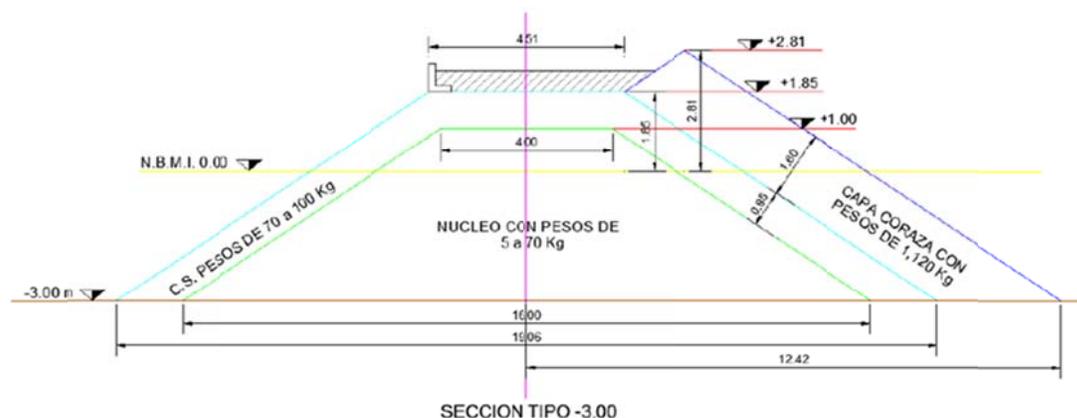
Sección tipo de rompeolas con enrocamiento en tres capas..
